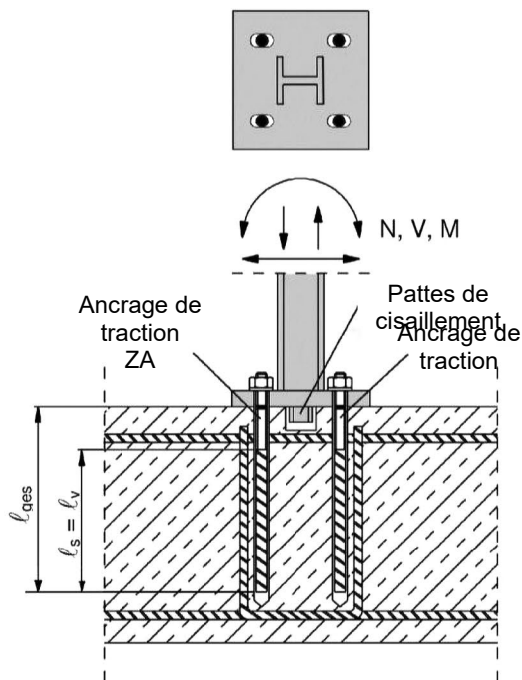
Joint de recouvrement pour l'ancrage des poteaux de barrière
